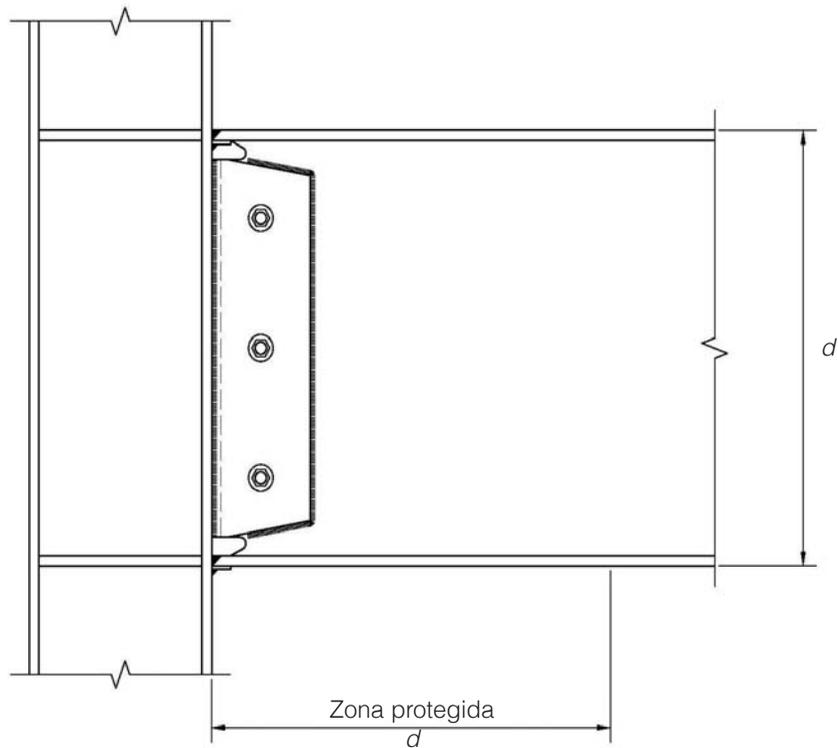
Elementos principales de la conexión ala soldada sin refuerzo y alma soldada (WUF-W).
